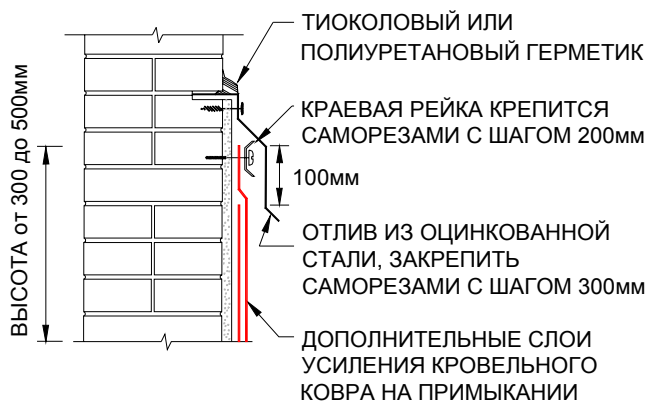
Закрепление края кровельного ковра на кирпичной стене.
